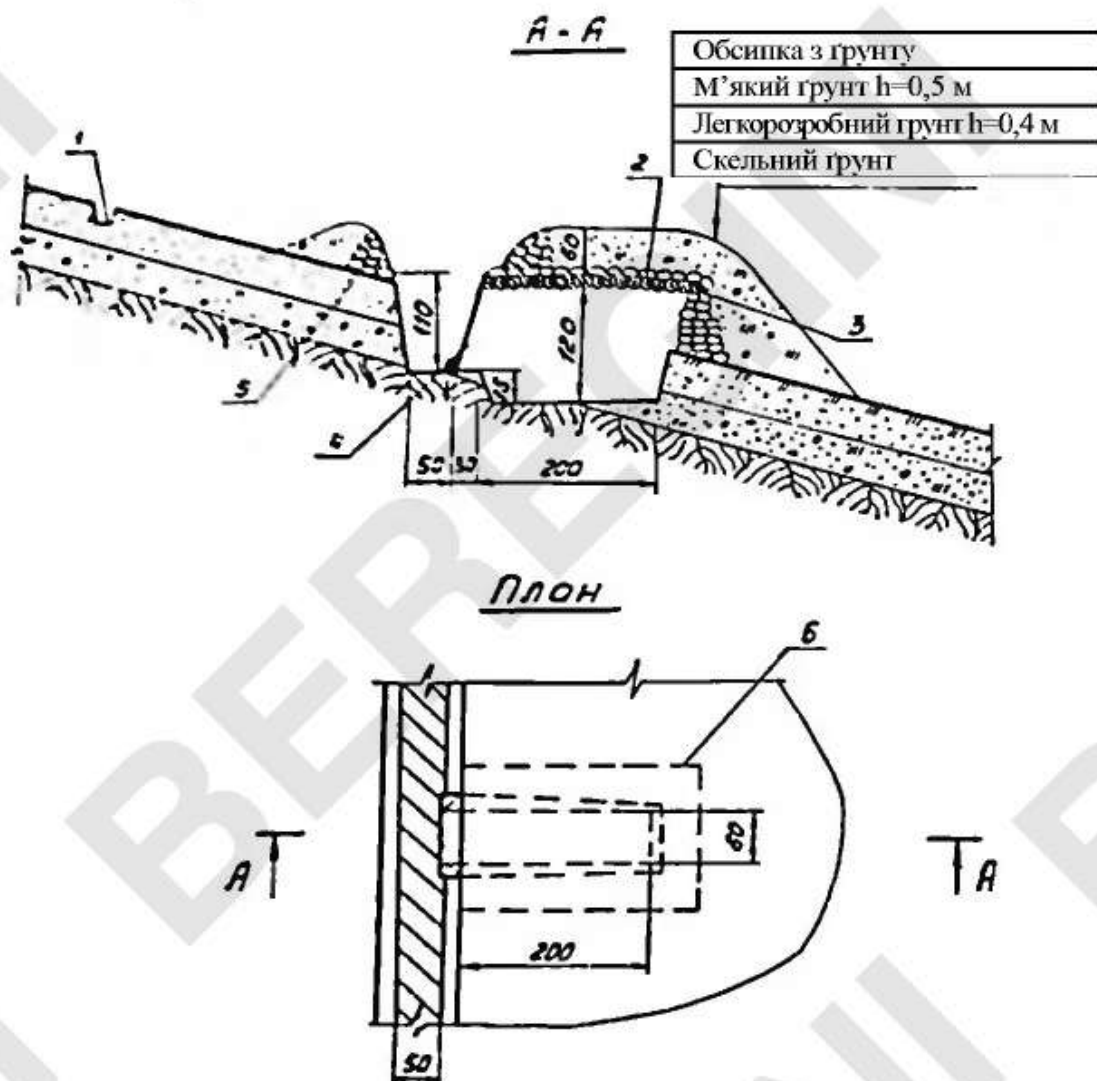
Ніша на 2 чоловіки з перекриттям із круглого лісу:
